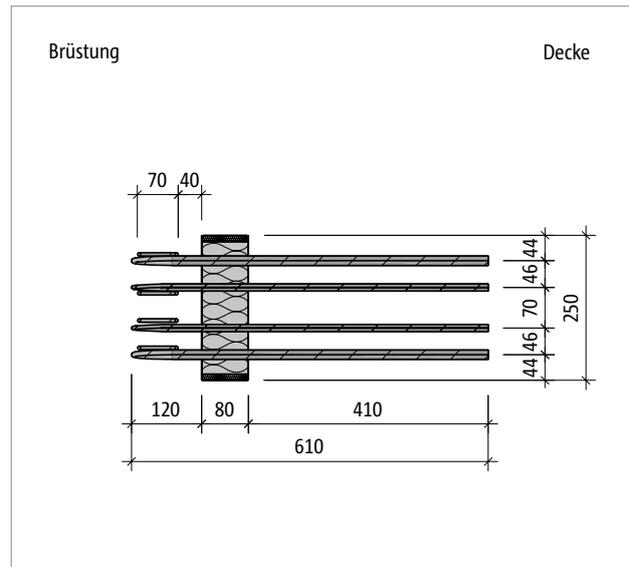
Schöck Isokorb® T Typ F-X80: Produktgrundriss
